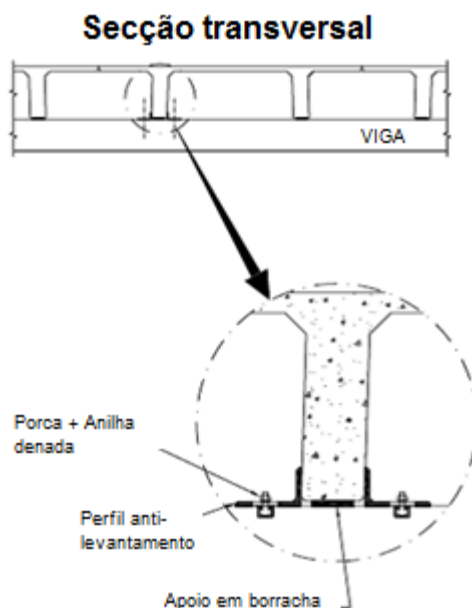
Intervenção para a ligação entre elemento de cobertura/pavimento e vigas – Ordem 2 – Tipo 6 [16]
